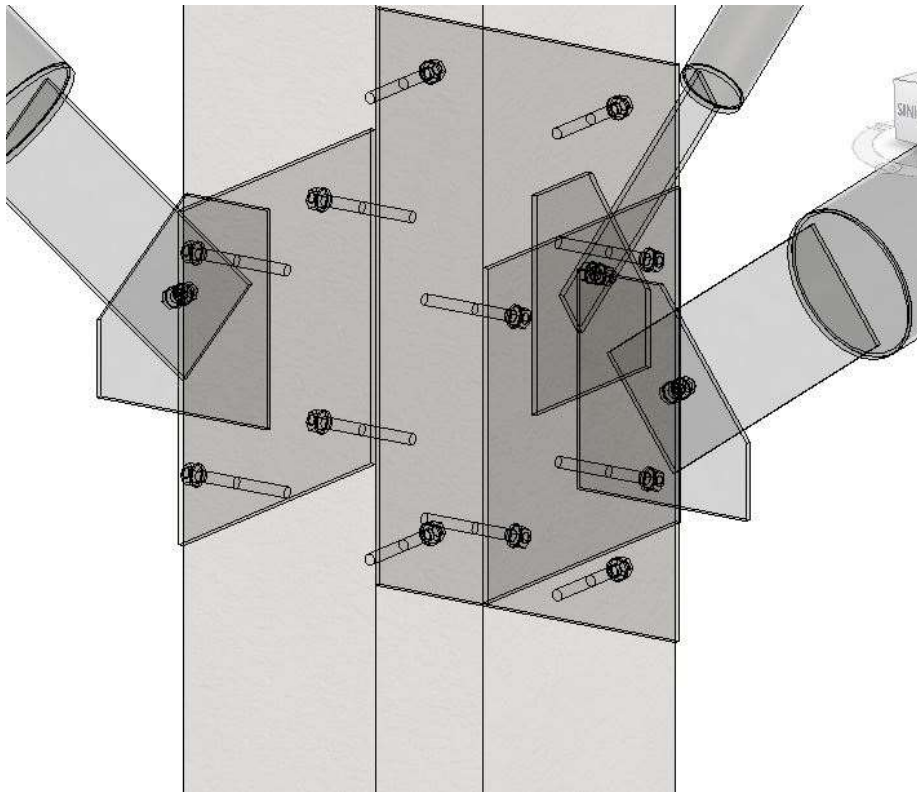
Vista complessiva della disposizione dei tasselli nel pilastro
